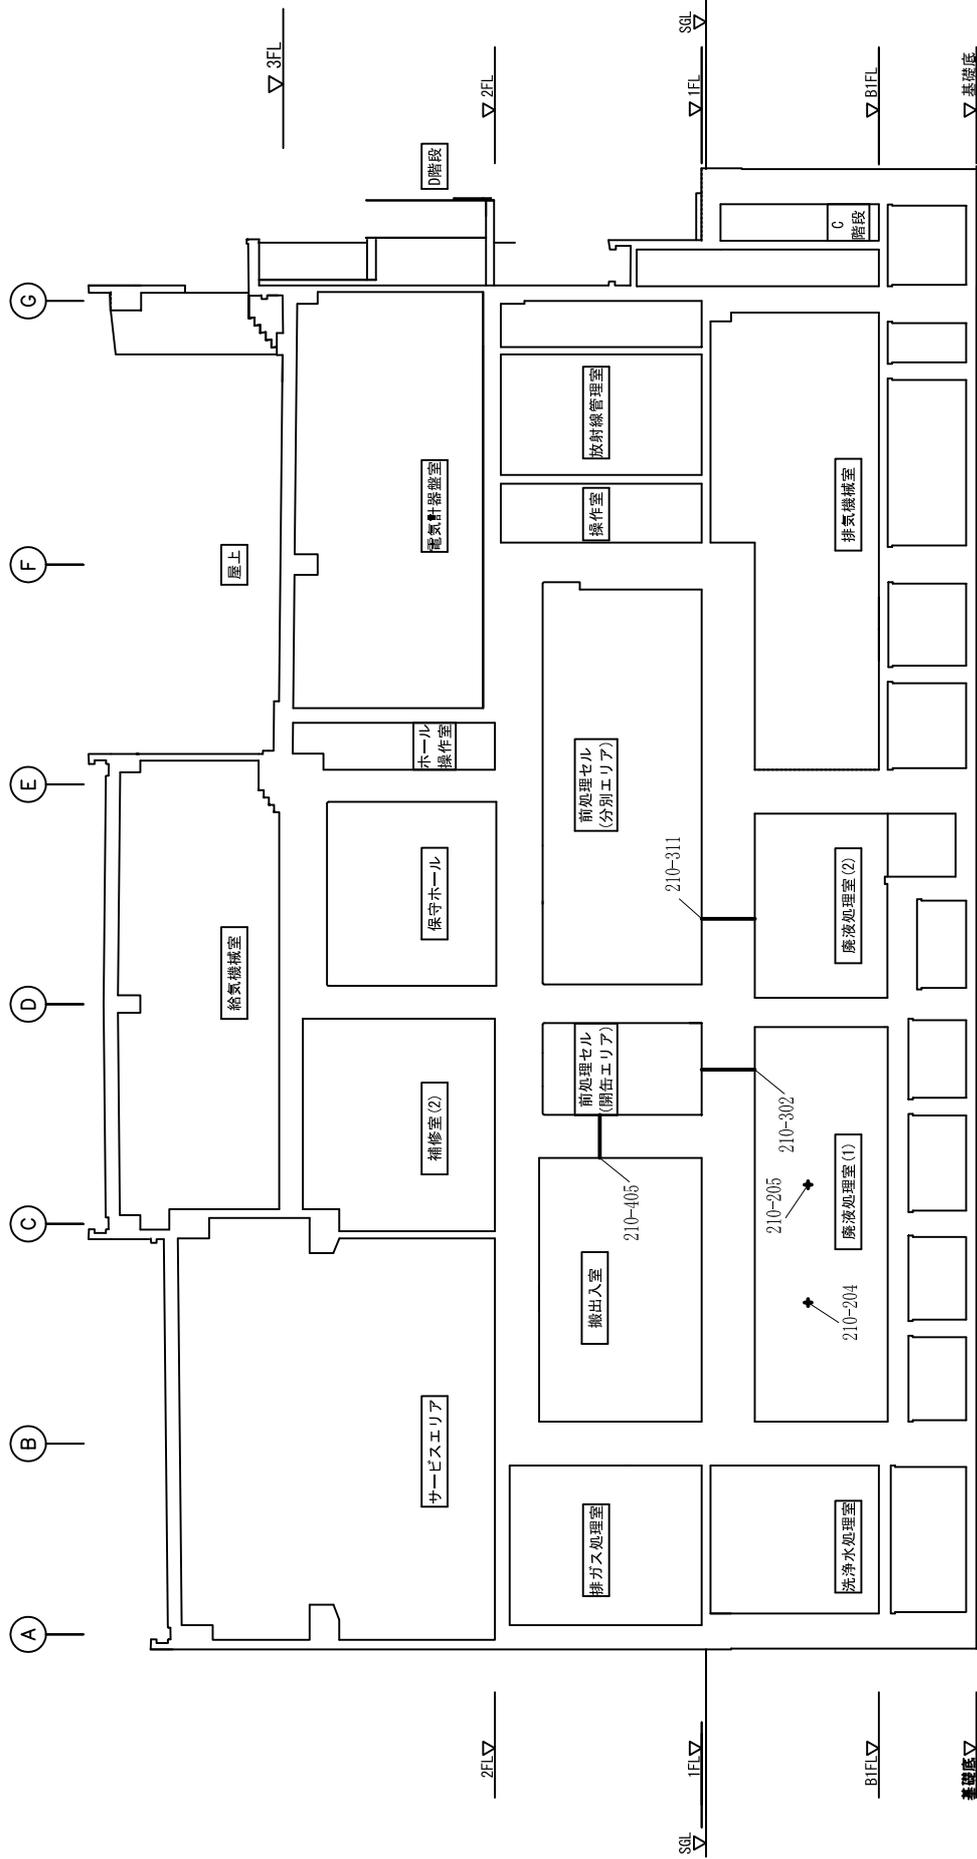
セル系排気設備の配管類 (埋設部) 配置図 (②~③間断面図 (1))
